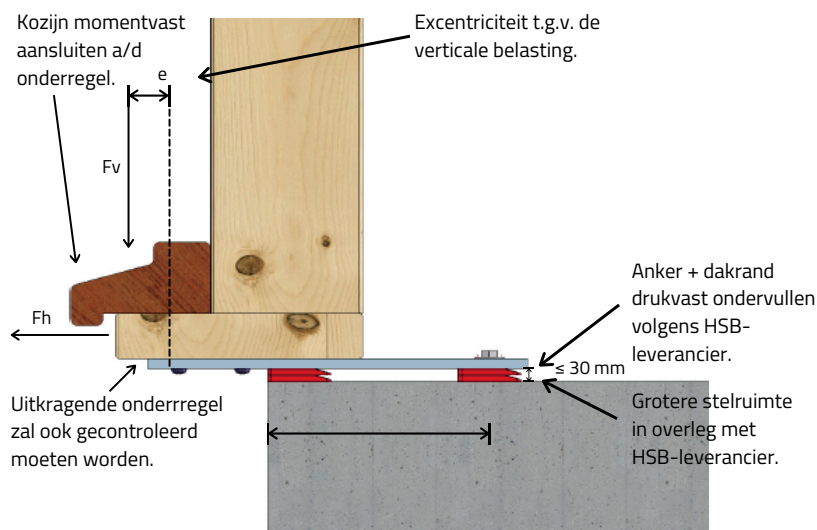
Bevestiging onderzijde HSB-wand a/d betonvloer met de strip uitkragend. Geldt voor het S02-/S03-/S04- en S05-anker.
